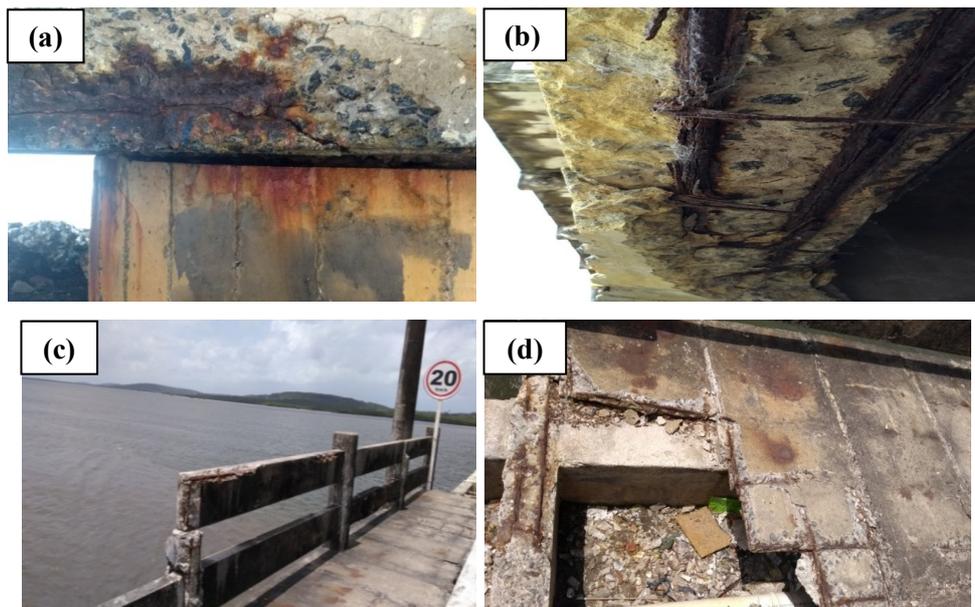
Corrosão no encontro pilar/travessa (a), na travessa (b), colapso do guarda corpo (c) e passeio (d).
